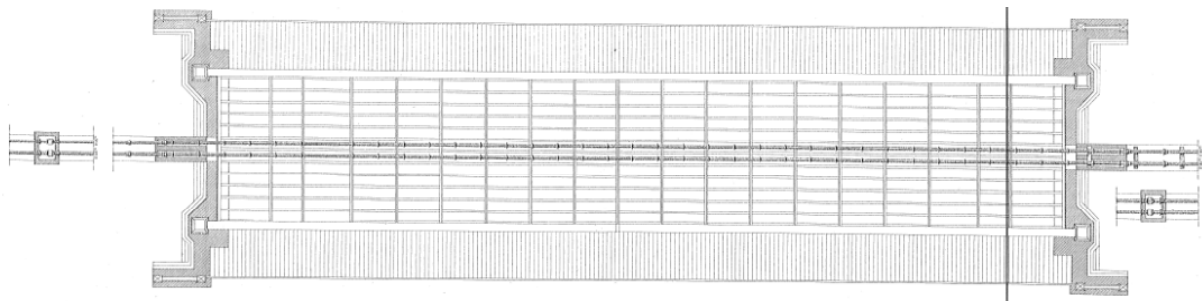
Grundriss Übersetzung des Donaukanals in der Brigittabrücke
